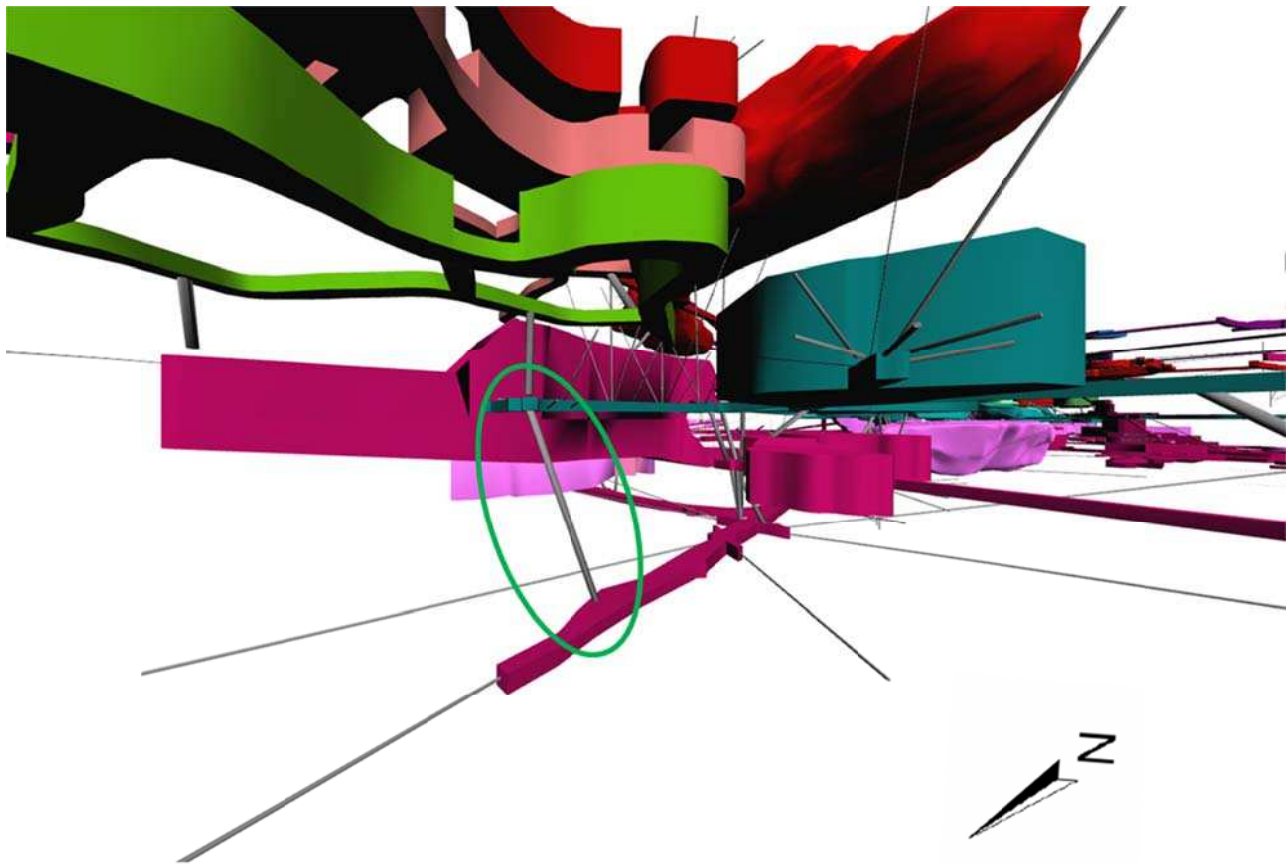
Detaildarstellung Lokation 2 (15YER22/RL006).
